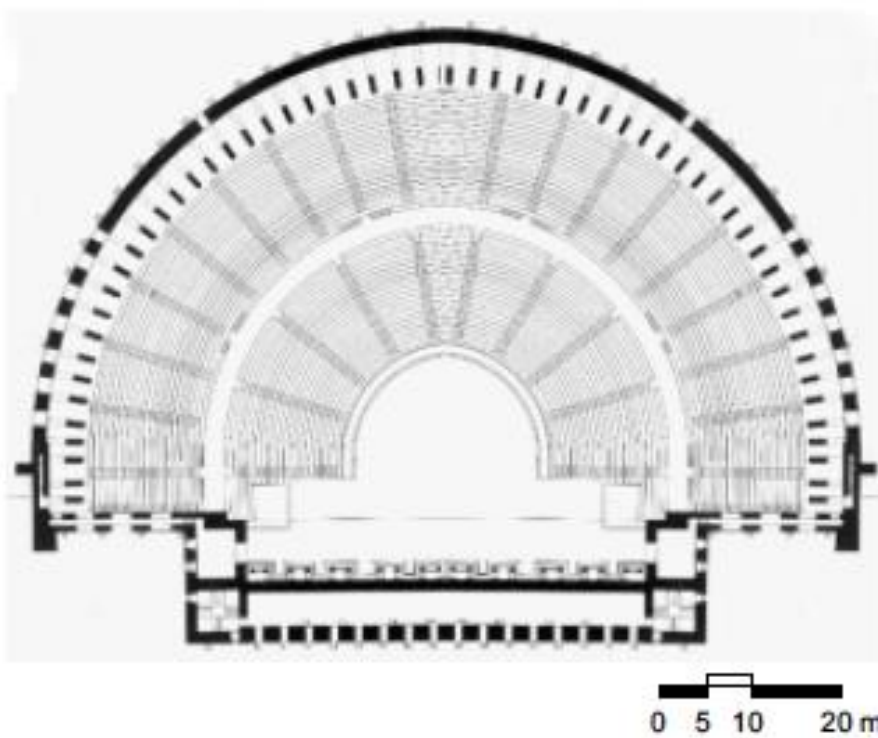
Planta del teatro de Apendus, Turquía. [1]
